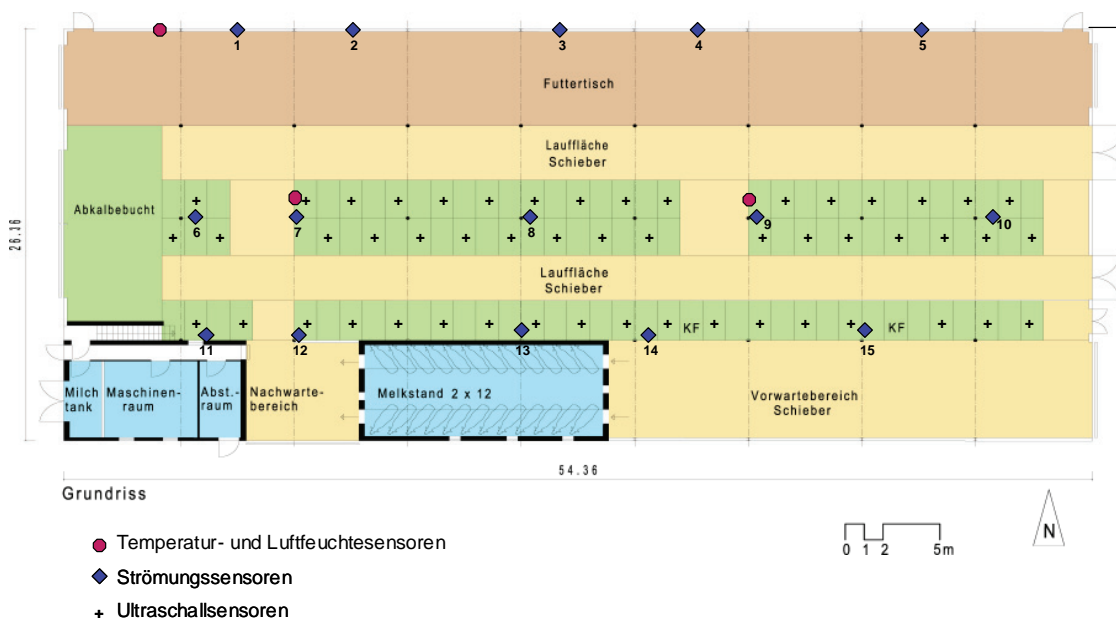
Grundriss des Betriebes B und Verteilung der Sensoren
